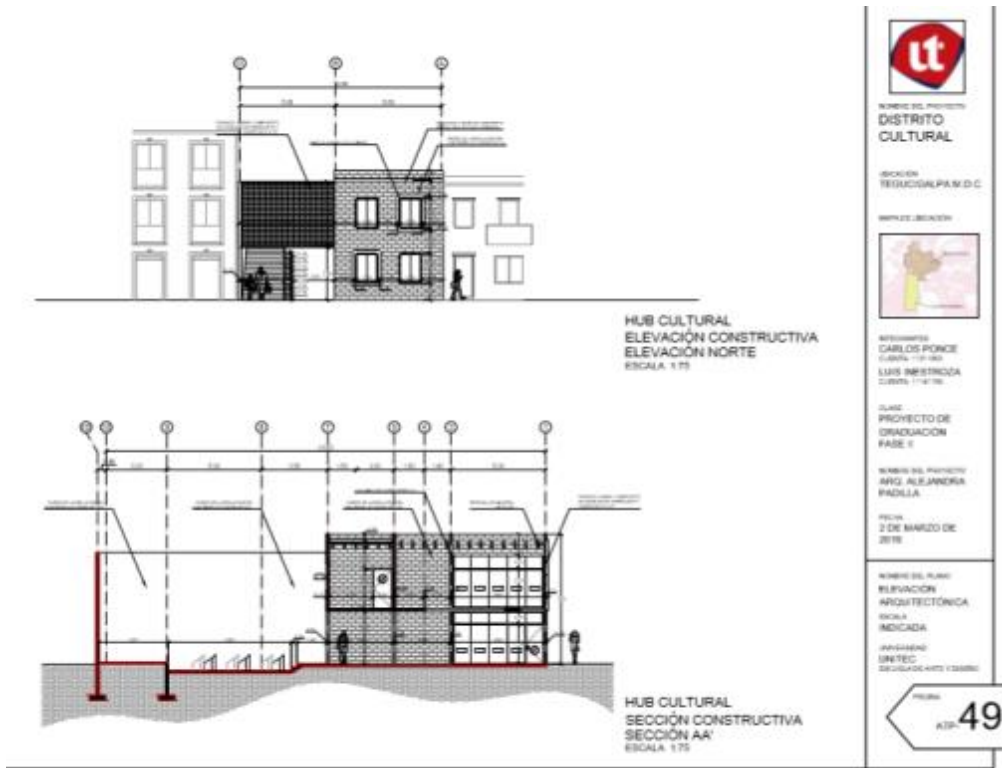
Elevación y Sección Constructiva Hub Cultural
